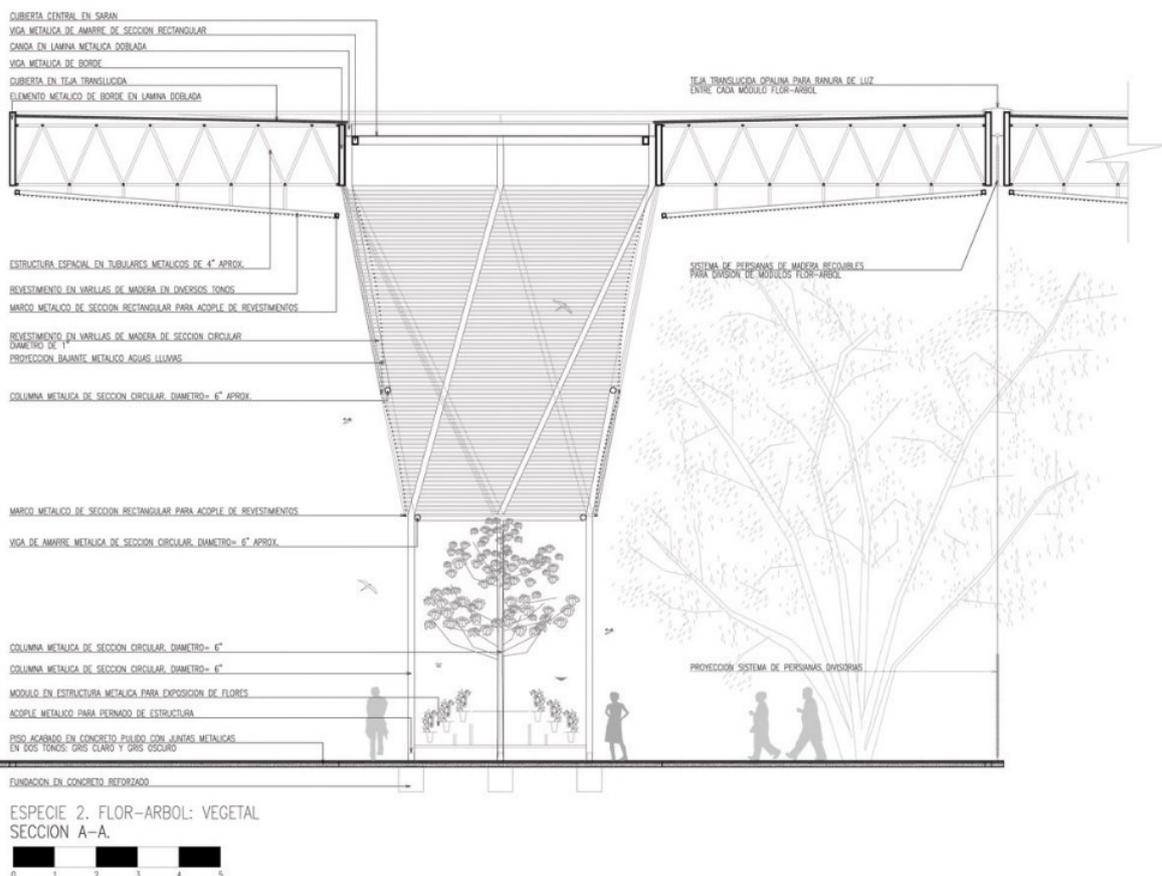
Разрез по опоре и навесу над ботаническим садом университета в г. Медельине
